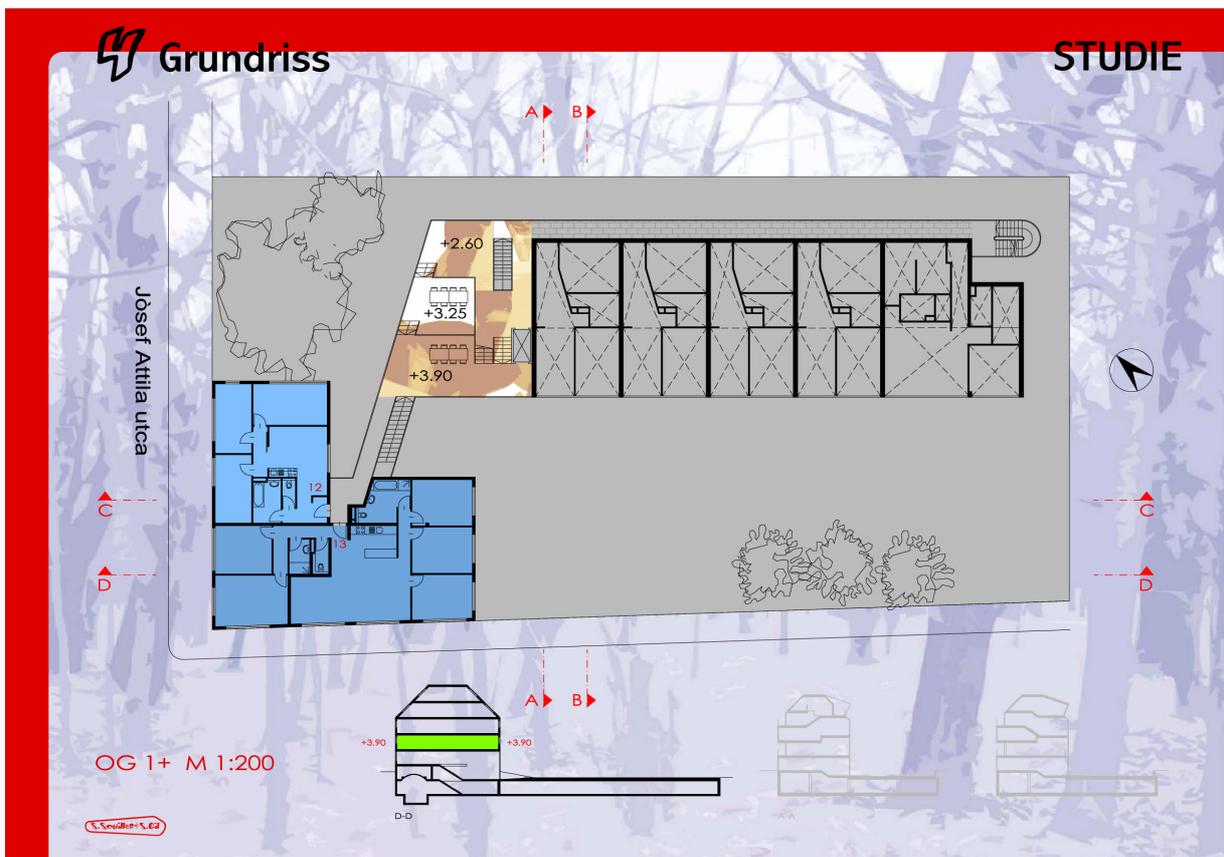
Auszug aus Planung - Grundriss
